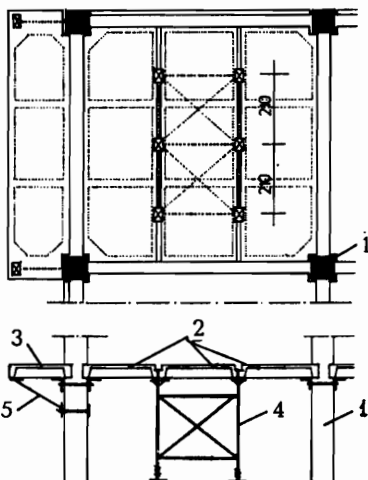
Технология монтажа составных плит перекрытия с применением подмостей: 1 – колонны; 2 – составные плиты перекрытия; 3 – консольный элемент; 4 – подмости с механическими домкратами; 5 – кронштейны для временного крепления консольных плит
